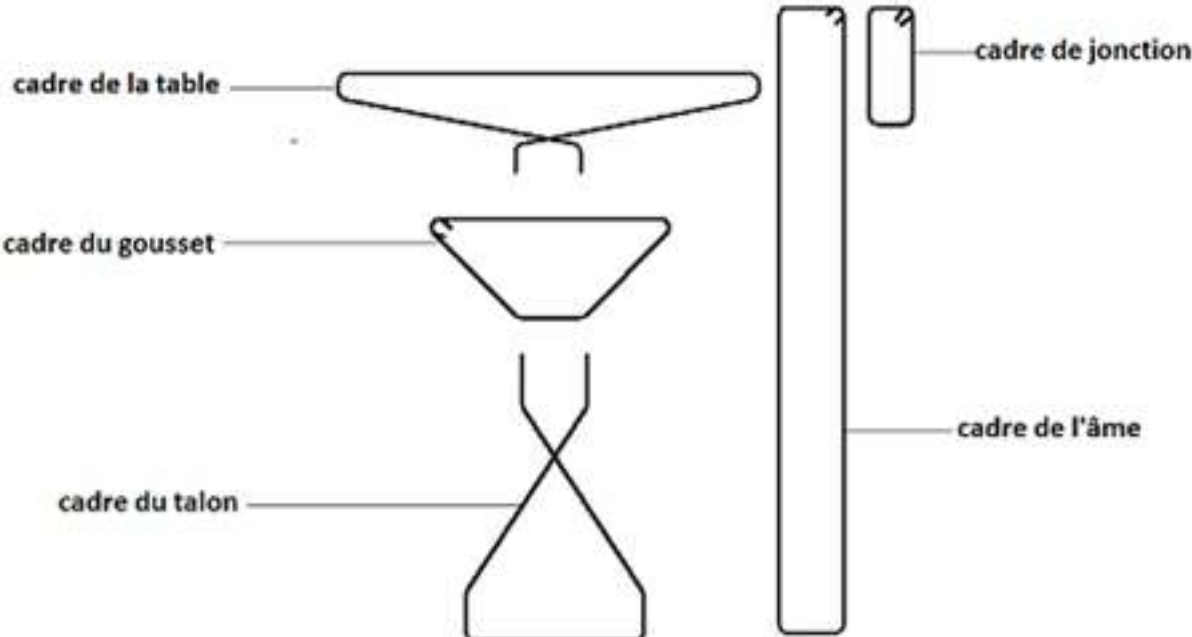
Détail du ferrailage transversal passif de la poutre
